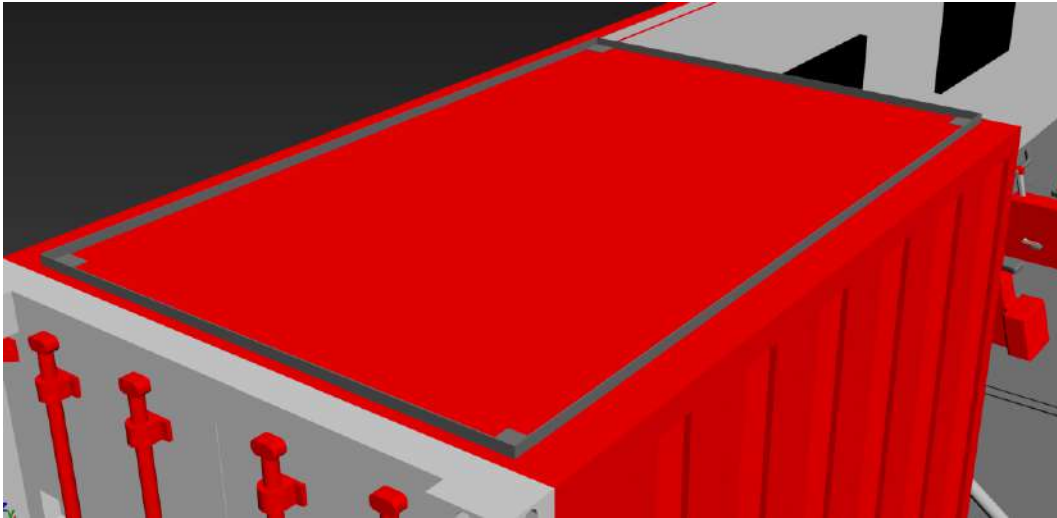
Render detalle soporte de las placas container “Fuente: Elaboración propia”
